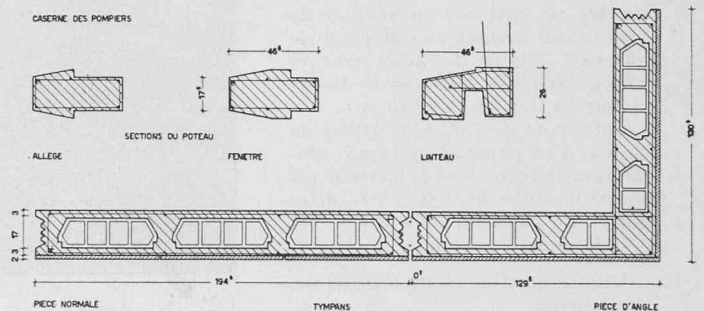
Détail des pièces préfabriquées (ossature et mur plein). Echelle 1 : 40.
